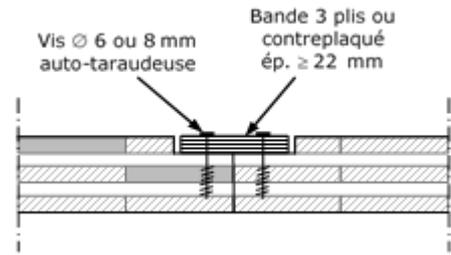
Assemblage par interposition d'une bande de liaison (joint languette)
